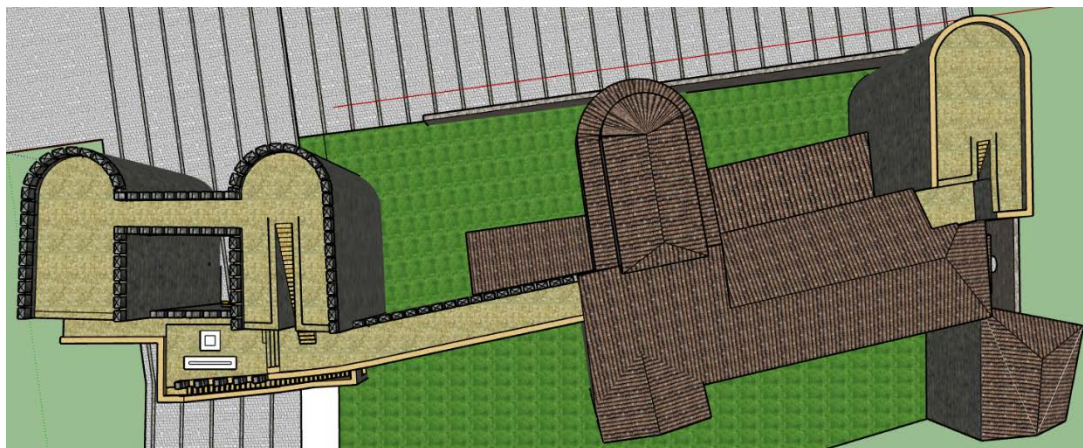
Vista en planta muralla Puerta de Alcázar antiguo del año 1867.
